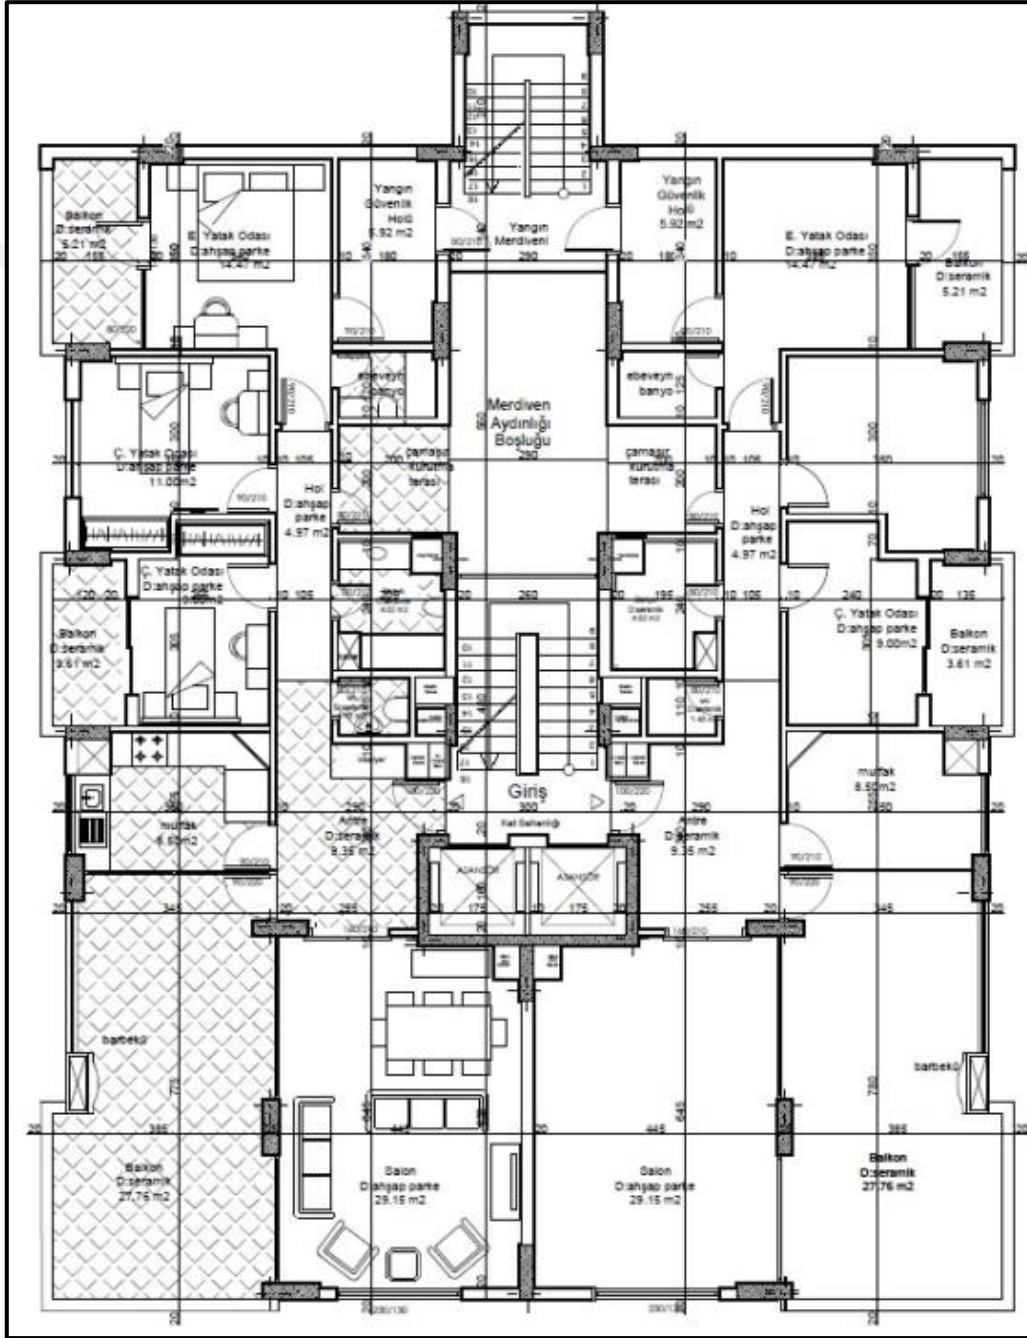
3. Örneğe ait arsa üzerinde yapı ruhsatı alınan mimari projeye ait vaziyet planı
